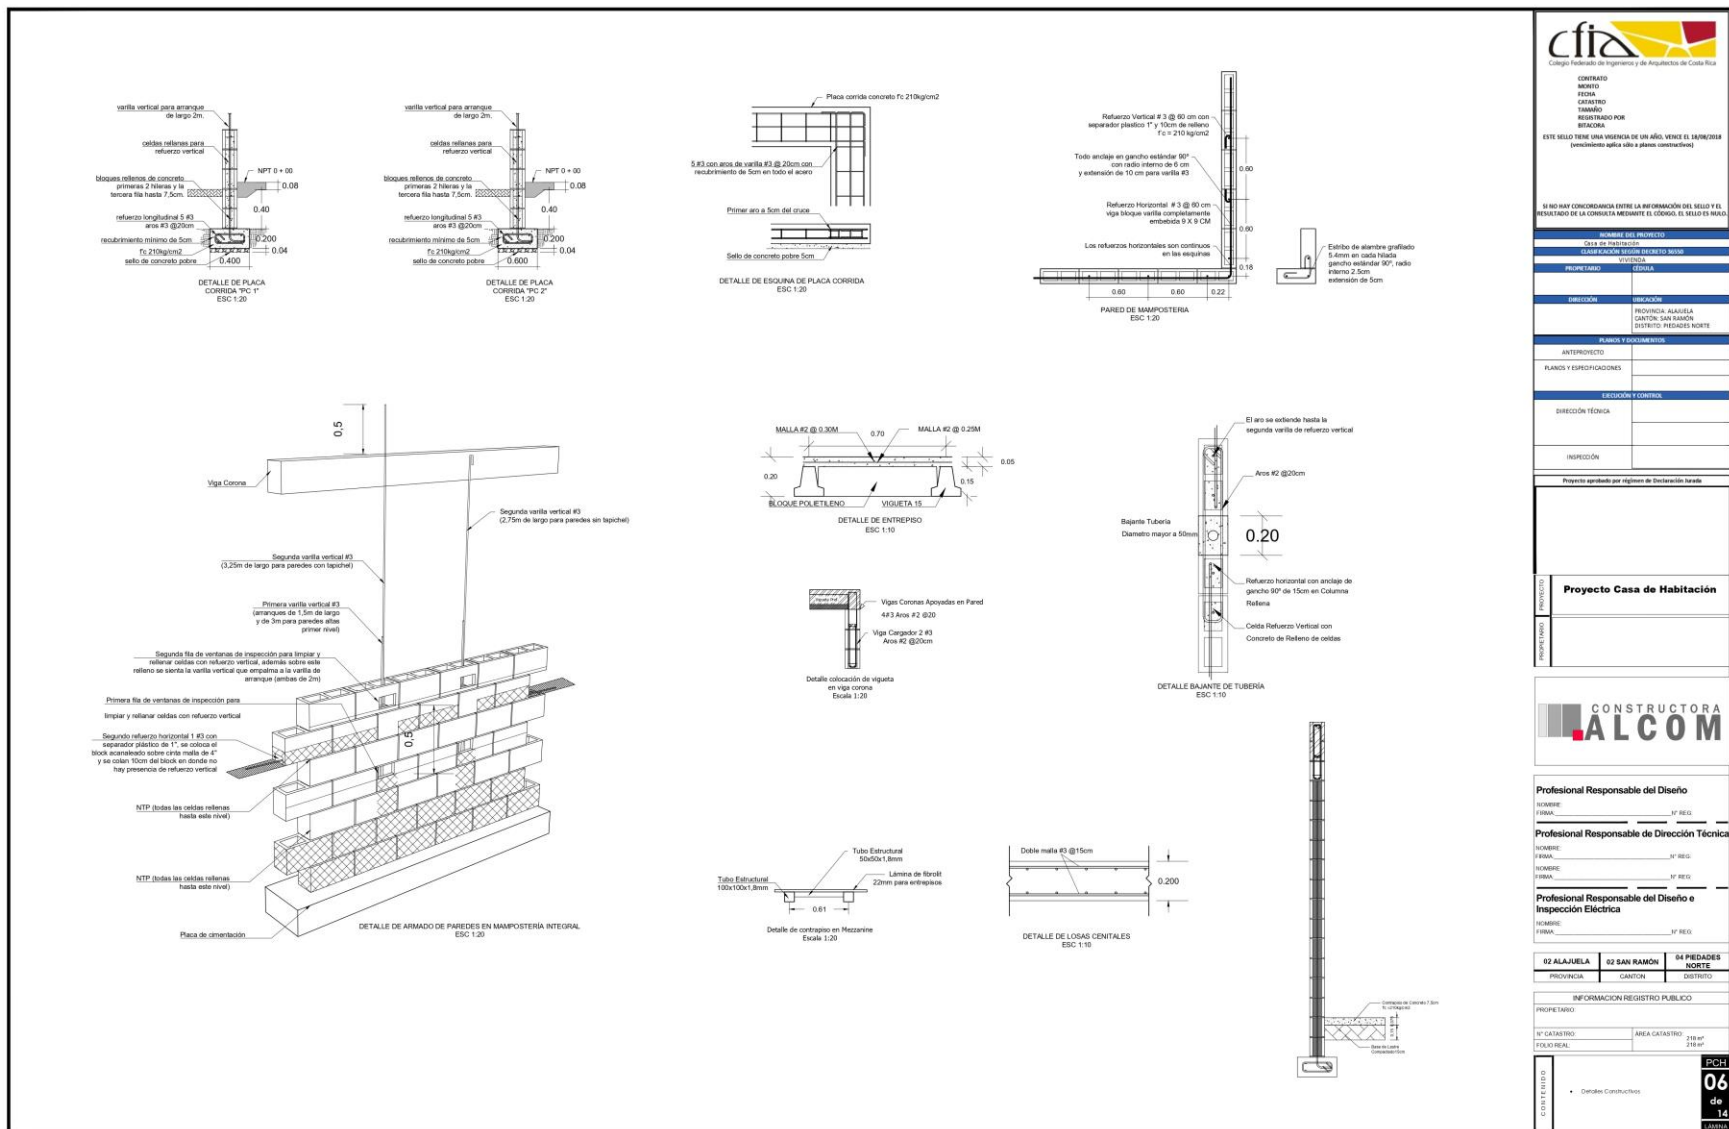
Planta de Cimientos y Refuerzo Vertical Proyecto Casa de Habitación.
